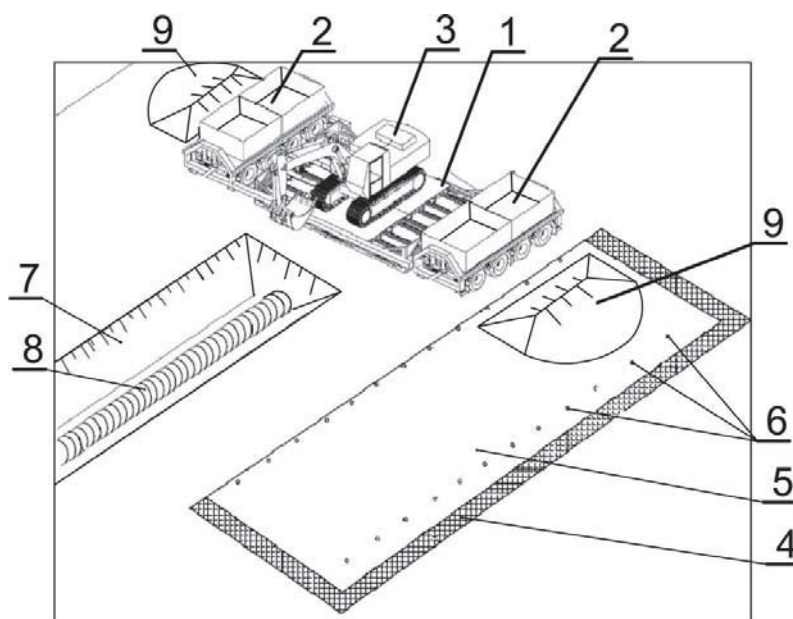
Разработанное устройство для вскрытия трубопровода в городских условиях [105].
